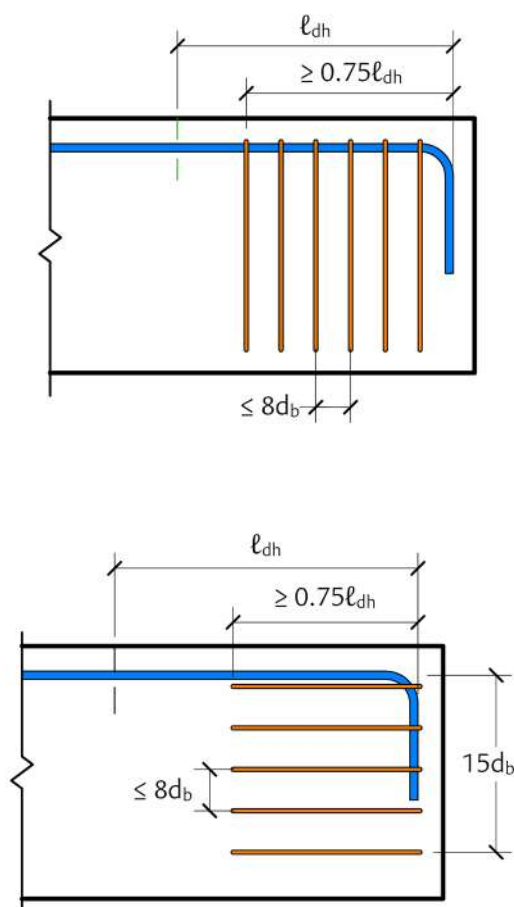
Refuerzo transversal que circunda la barra anclada con gancho.
